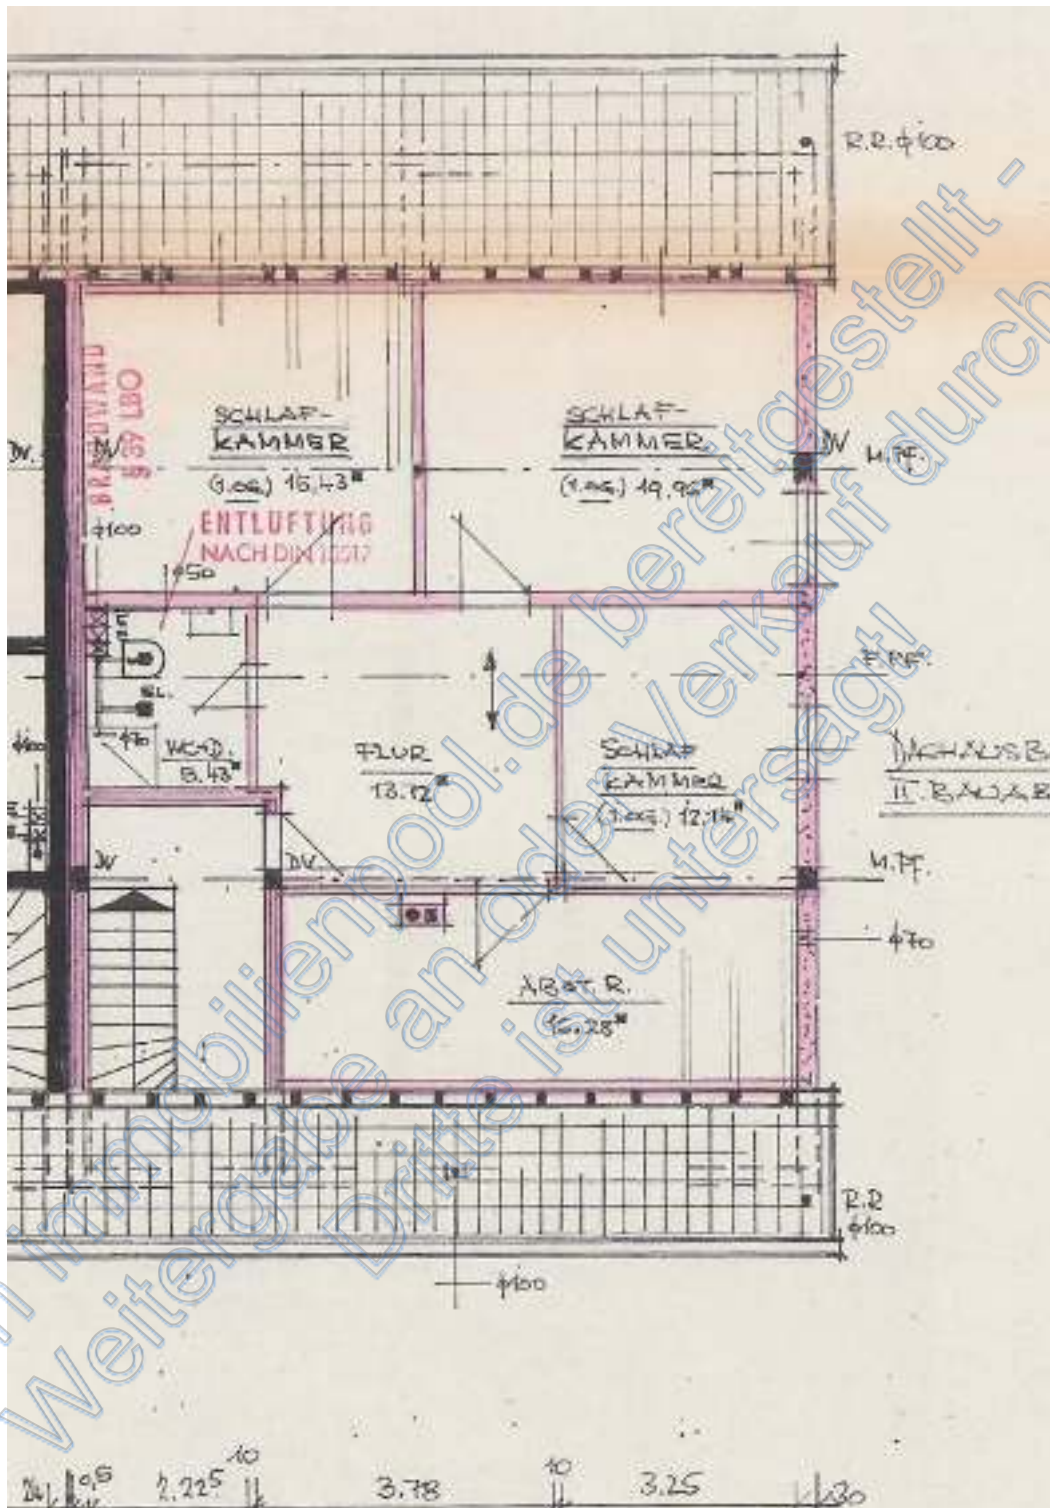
Grundrissplan Dachgeschoss (aus Bauakte)
